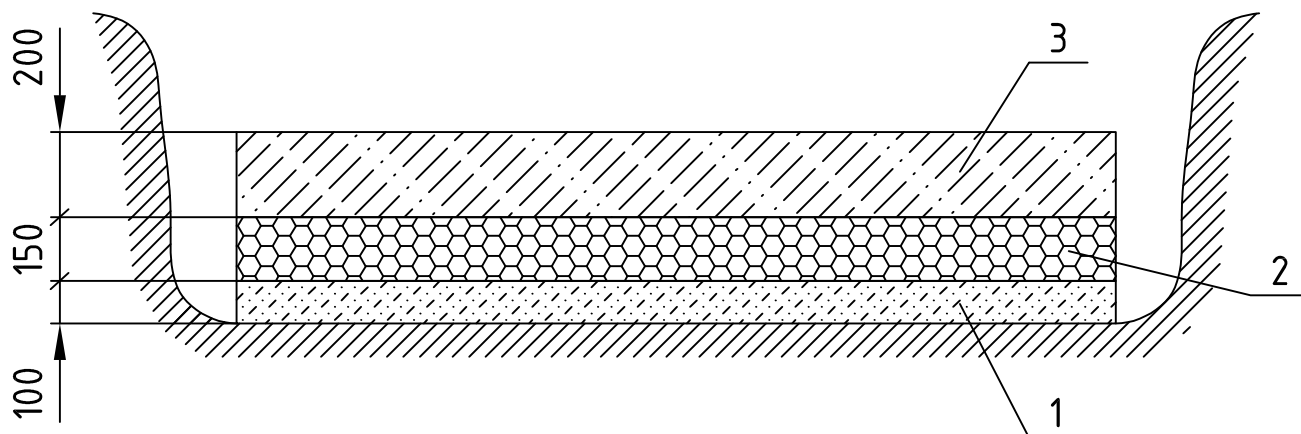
Рекомендуемая подготовка фундамента для установки
